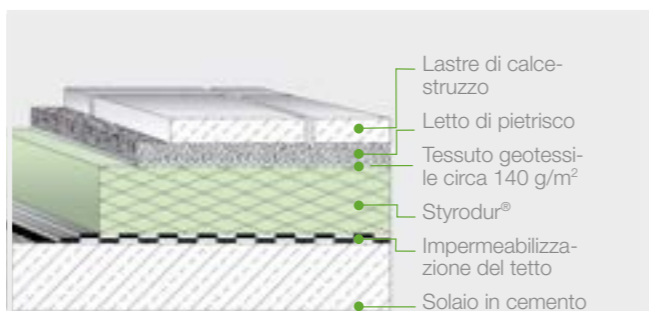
Struttura di un tetto rovescio a terrazza con lastre in calcestruzzo su letto di pietrisco.
